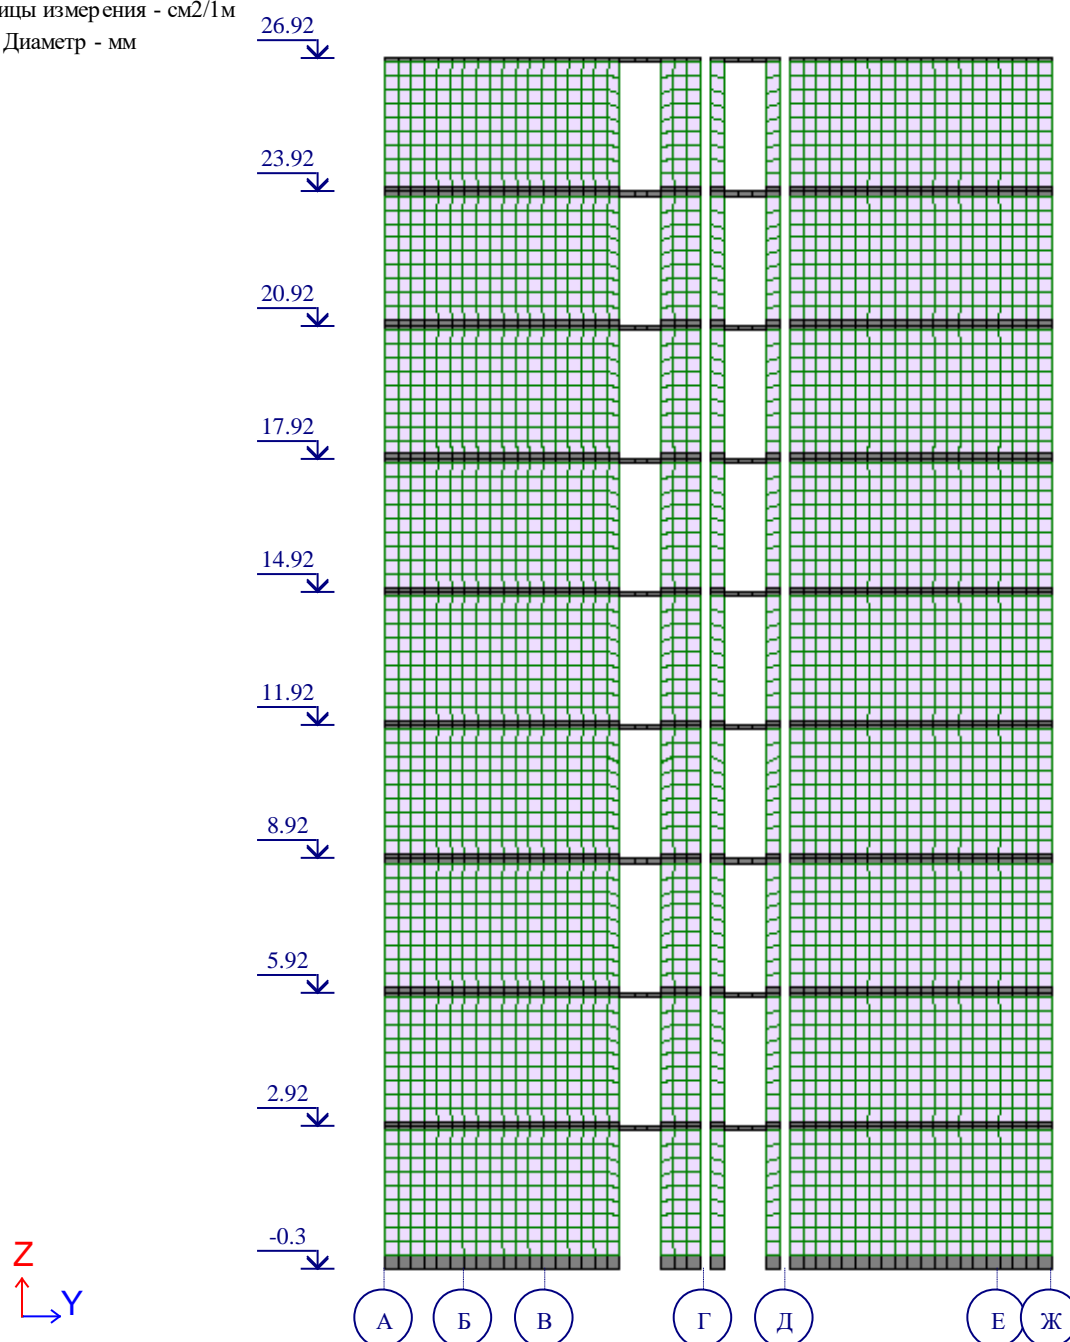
Площадь полной арматуры на 1пм по оси Y у нижней грани (балки-стенки - посередине)
